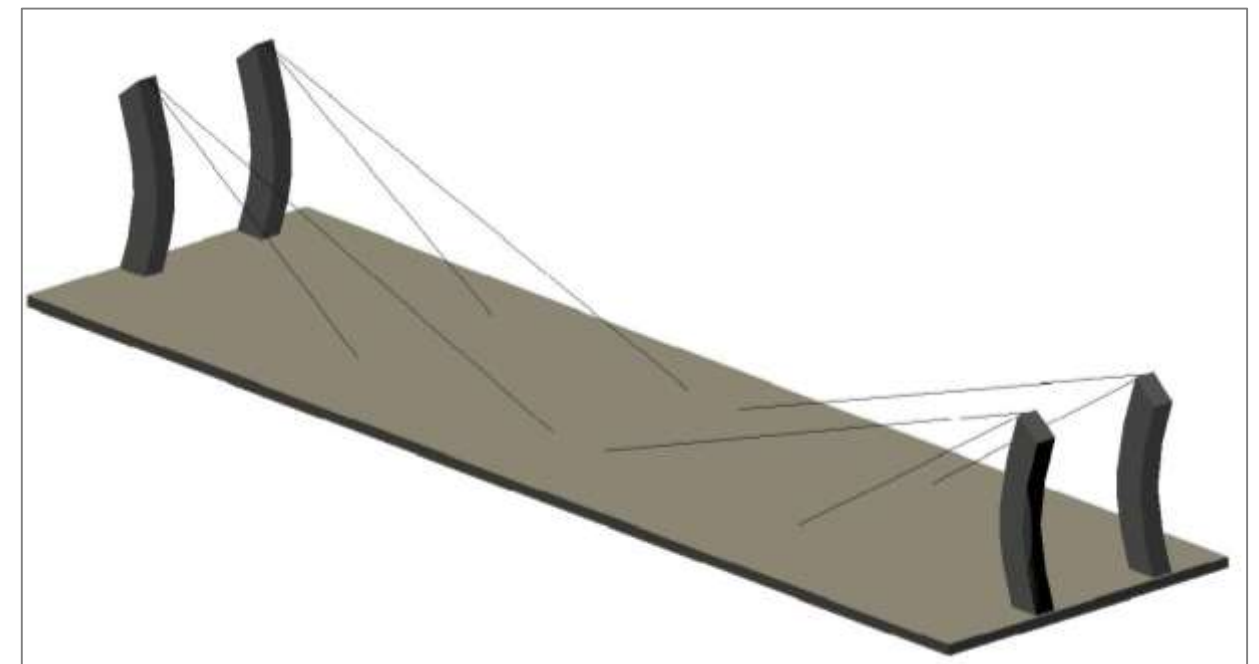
Vista superior del tablero y torres. Fuente: Elaboración propia.
